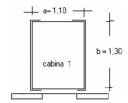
Dimensión de cabina. Fuente: Instalaciones electromecánicas
